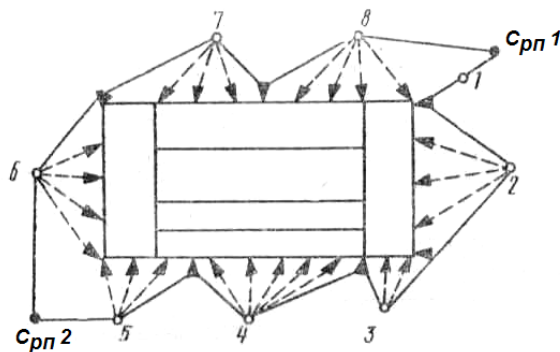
Схема нивелирования фундаментов здания с использованием осадочных марок
